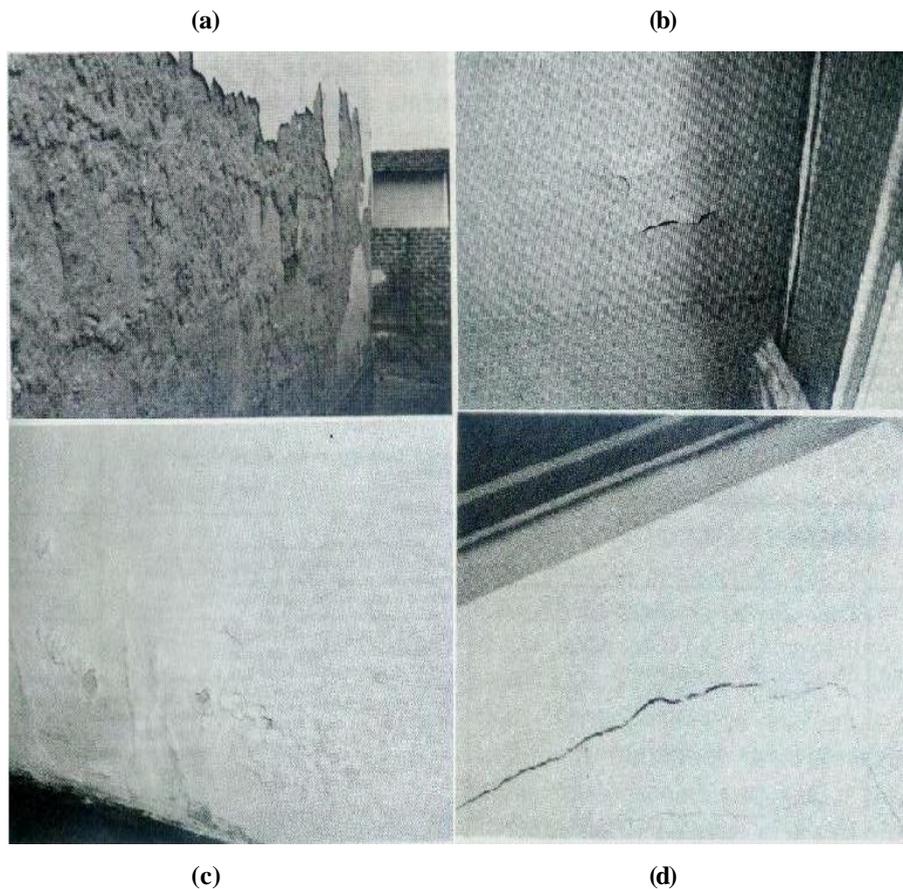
(a) Desagregação, (b) descolamento, (c) argamassa pulverulenta por umidade e (d) fissura. FONTE: CINCOTTO (1988).
